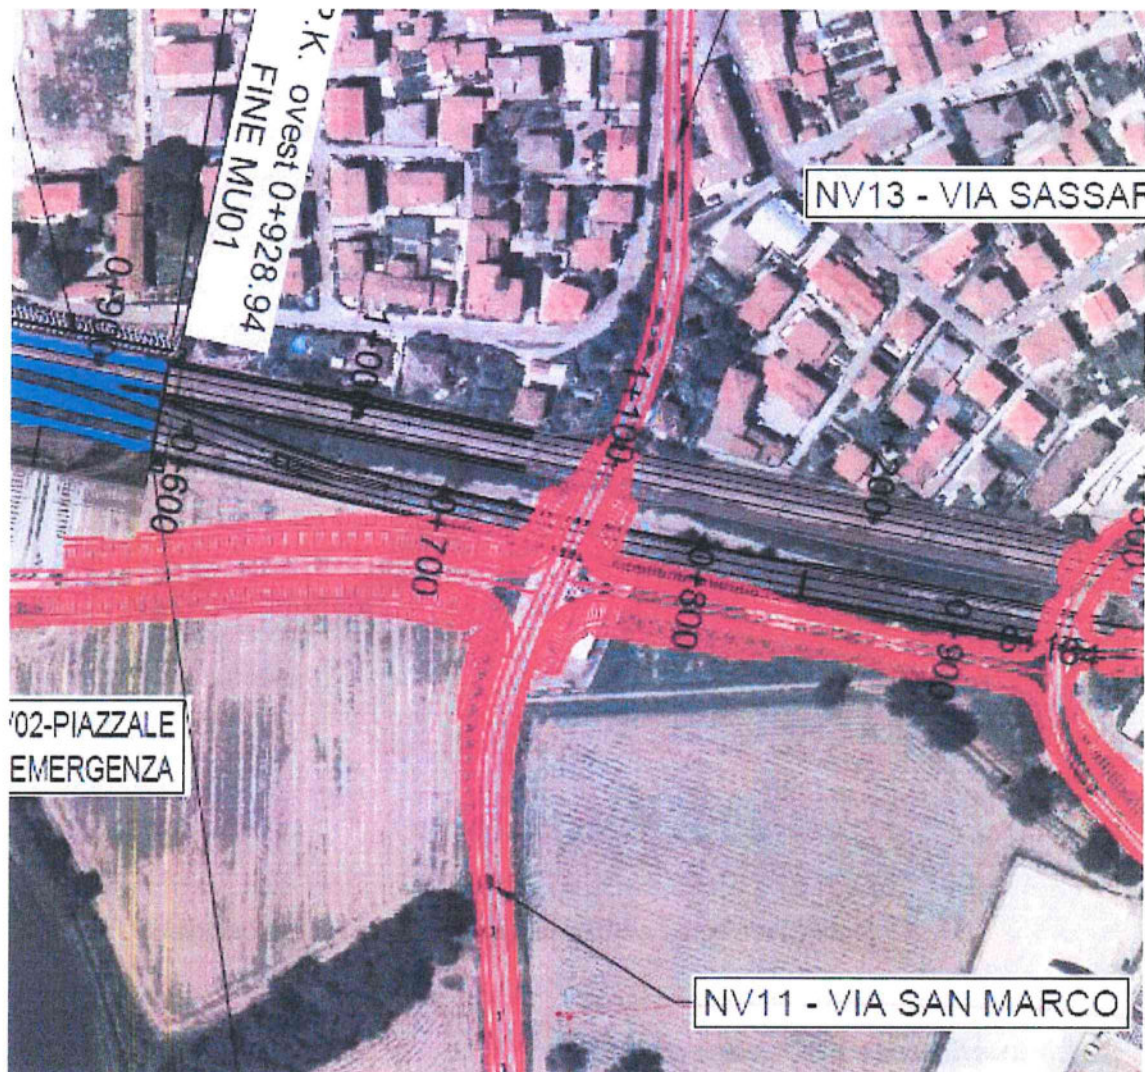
NV11 – Stralcio planimetrico su ortofoto Via San Marco.
